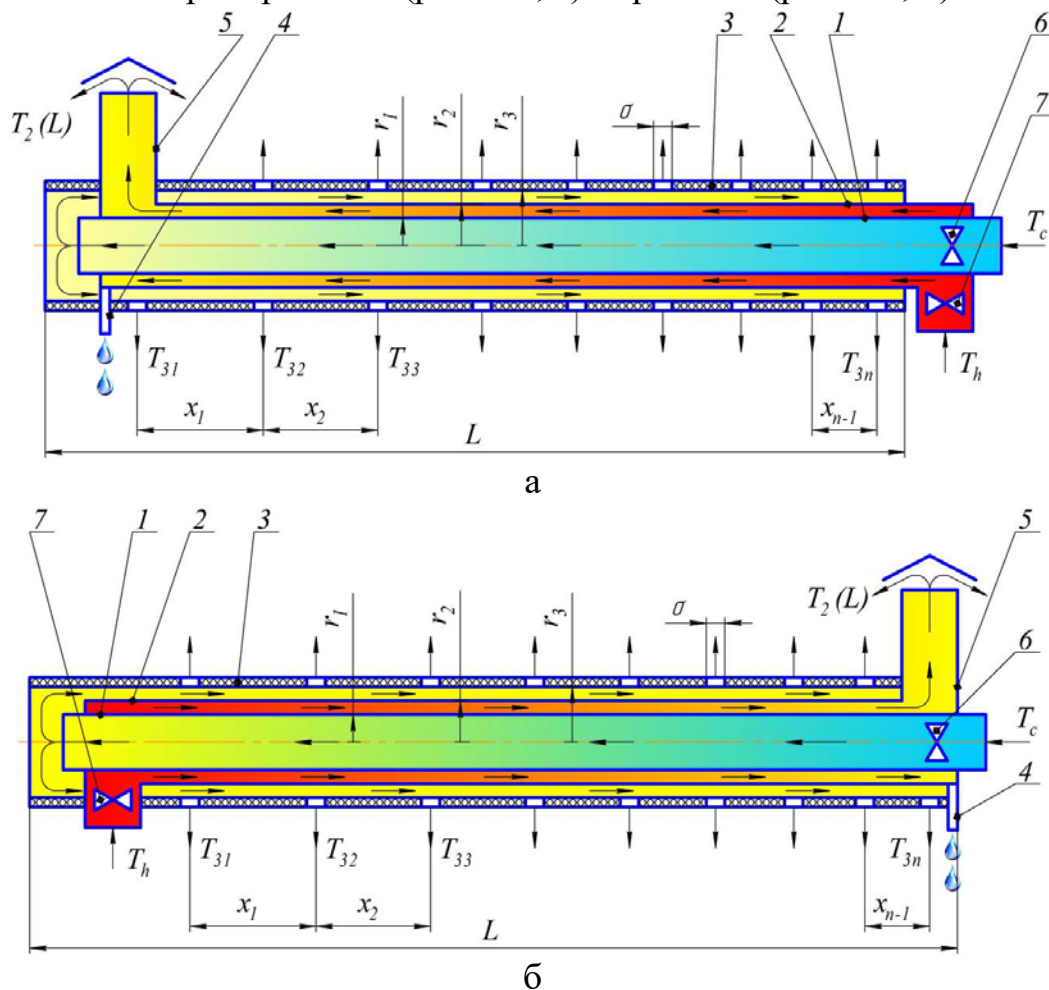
Технологічна схема тритрубного теплоутилізатора з основними параметрами: 1, 2, 3 - труби; 4 - трубка для відведення конденсату; 5 - витяжна шахта; 6 - припливний вентилятор; 7 - витяжний вентилятор
